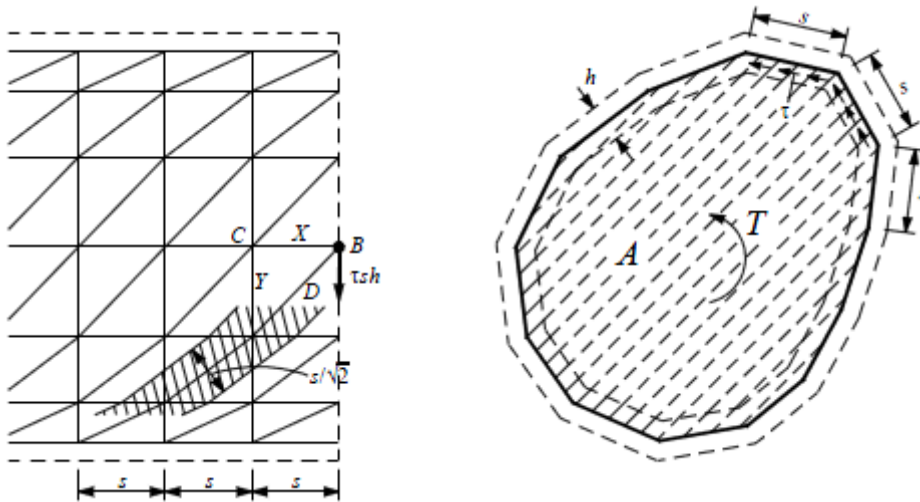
Treliça espacial para um tubo de betão armado com secção arbitrária (Estado II) [4]
